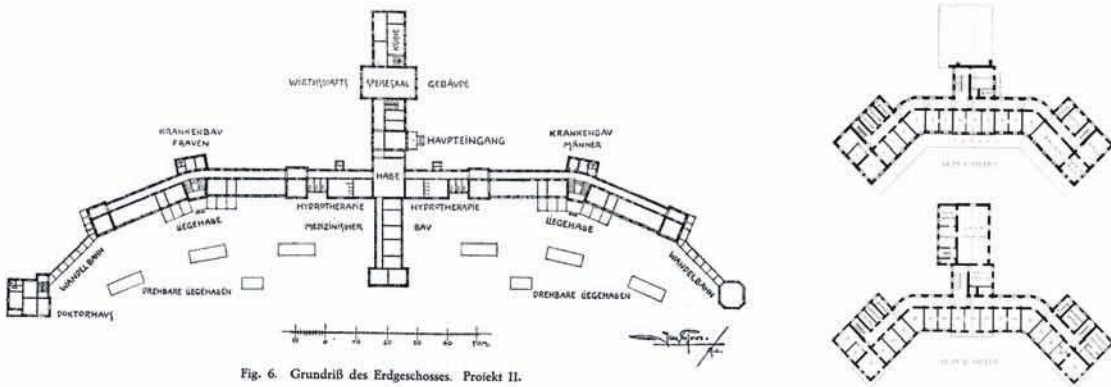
Grundriß des Erdgeschosses. Projekt II.
